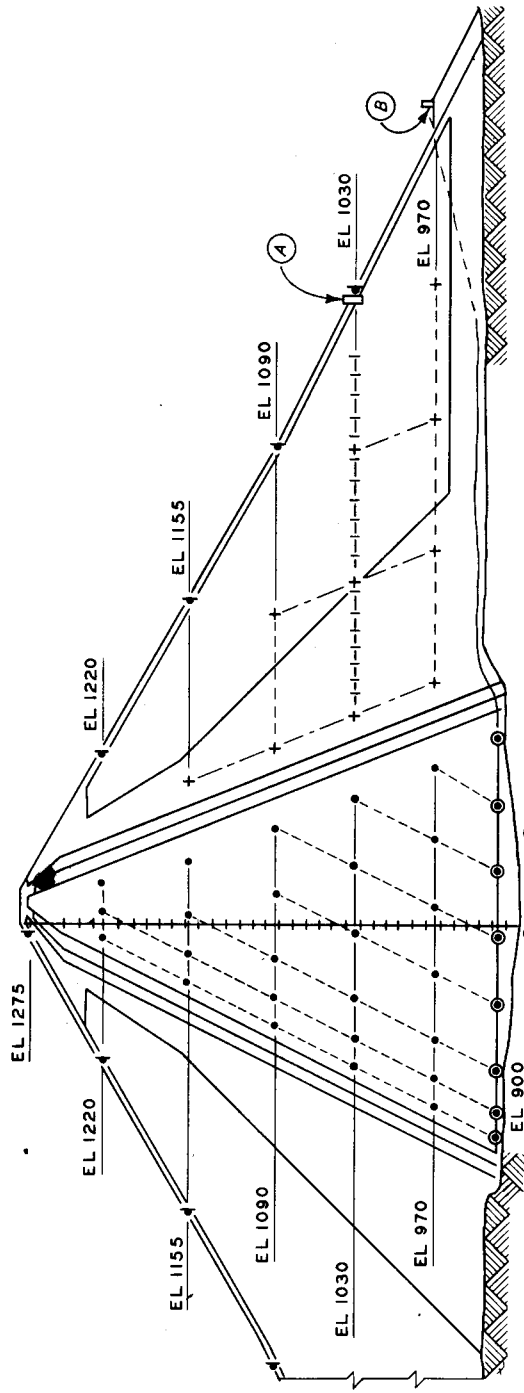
Barrage de BLOWERING (Autriche) : Section transversale type, emplacement des appareils.
